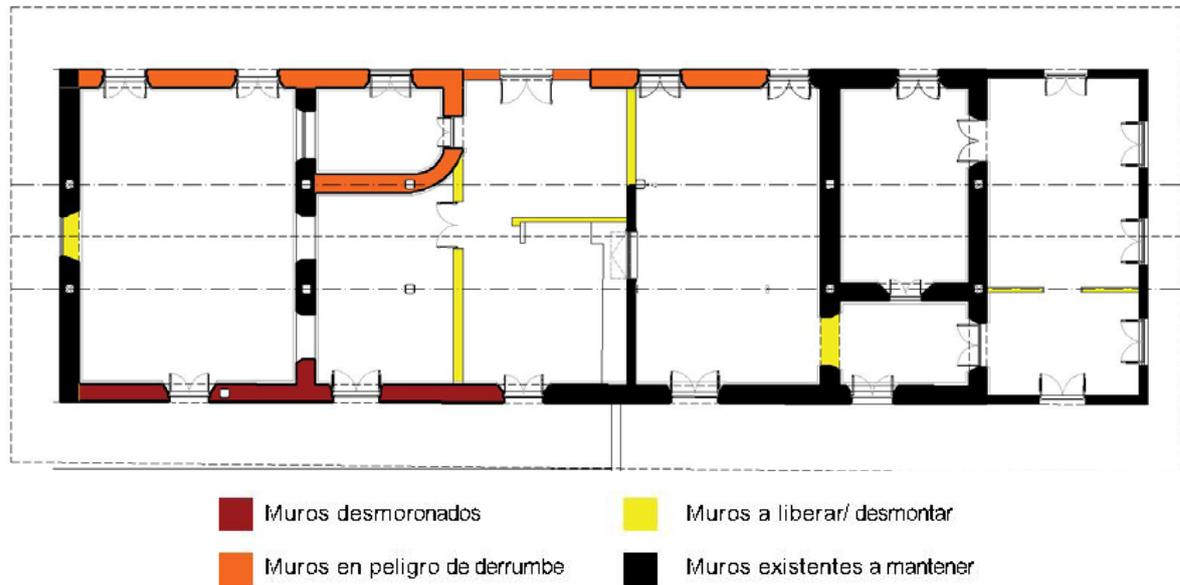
Planta de intervención (crédito: FADA UNA, 2017)
